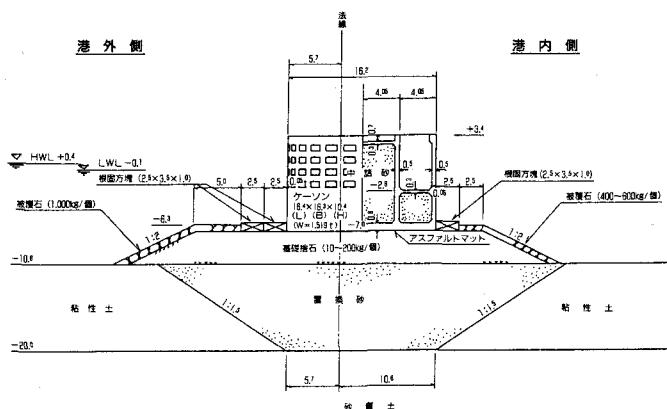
二重円筒ケーソン堤断面図 (R C 構造)
